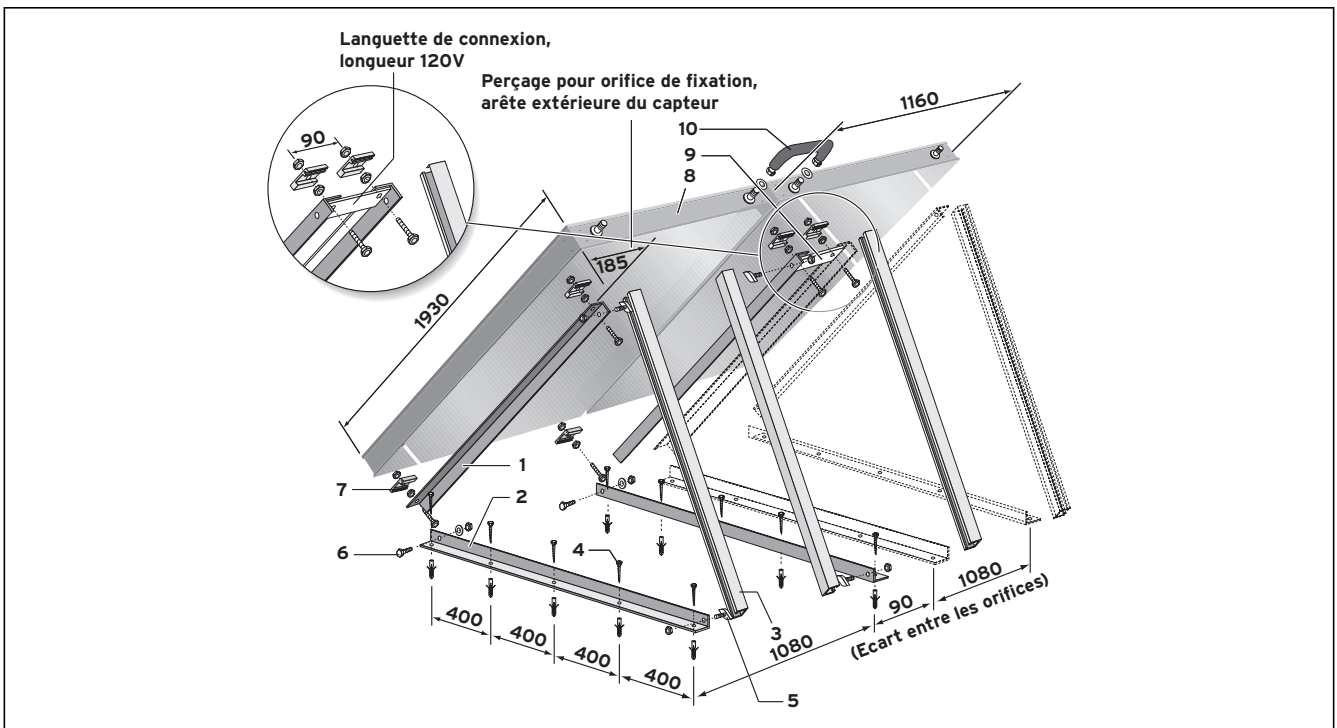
Module d'extension pour positionnement sur toit plat
